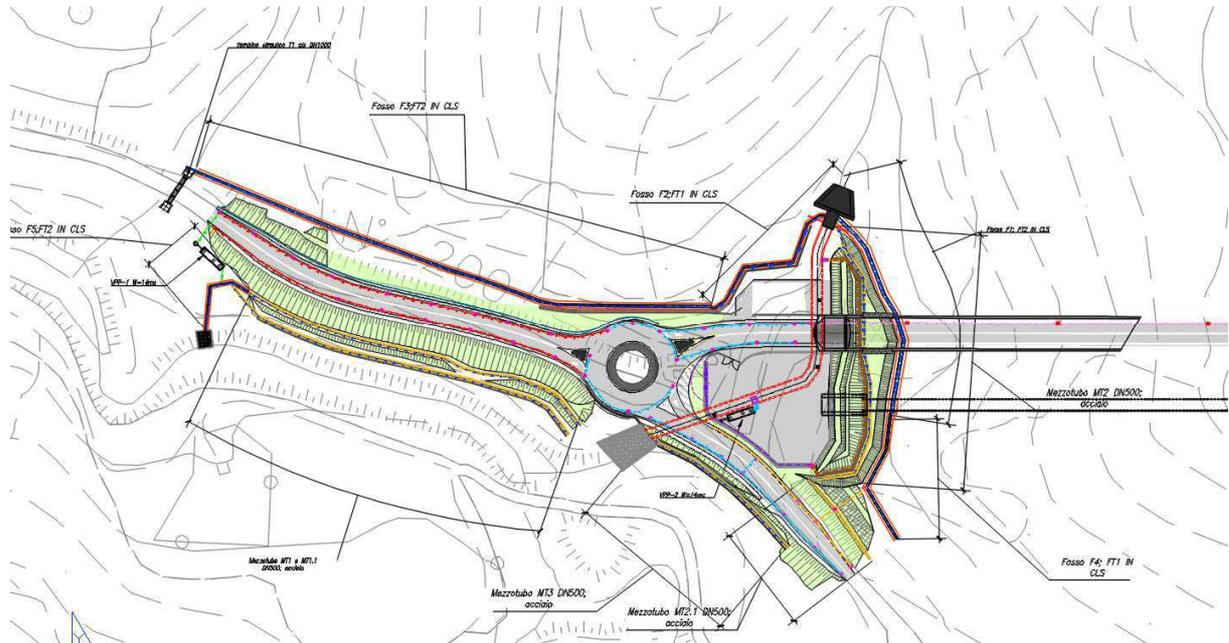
Planimetria Idraulica dell'intersezione Lato Umbria
